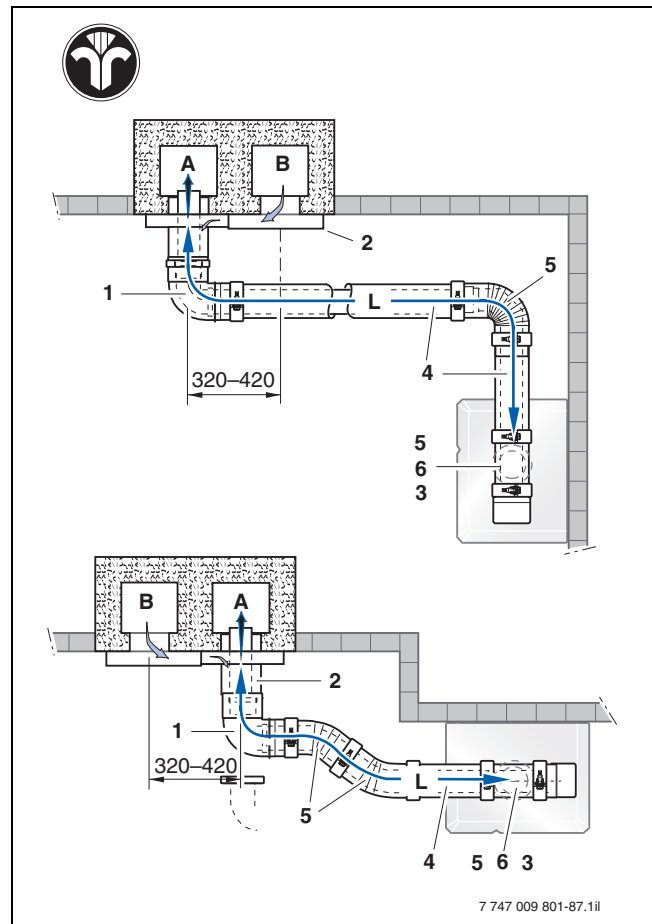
Montagevariante mit dem Bausatz LAS-P für U152 (Maße in mm);
